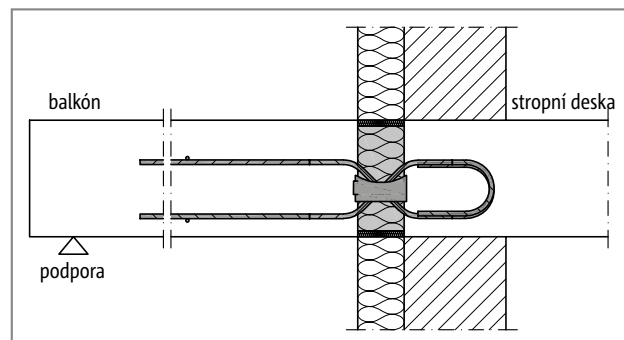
Schöck Isokorb® T typ QL: Podepřený balkón, nezateplené zdivo
